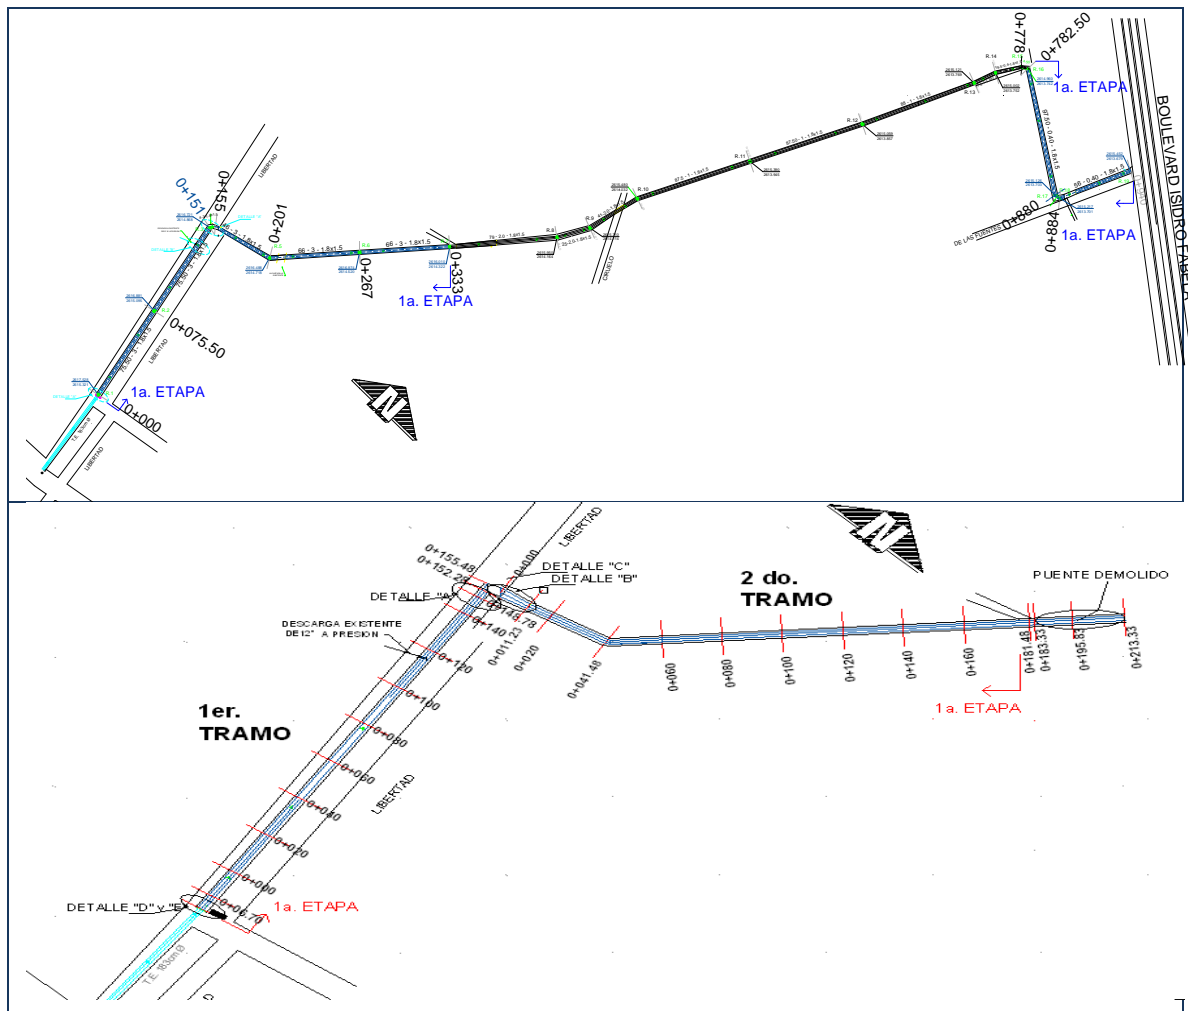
PLANTA DE BÓVEDA CASO I
